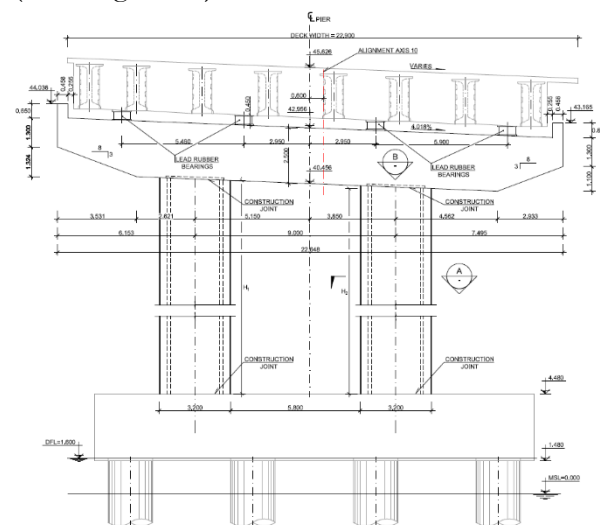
Alzado de pila CV10 del viaducto de Cebú
